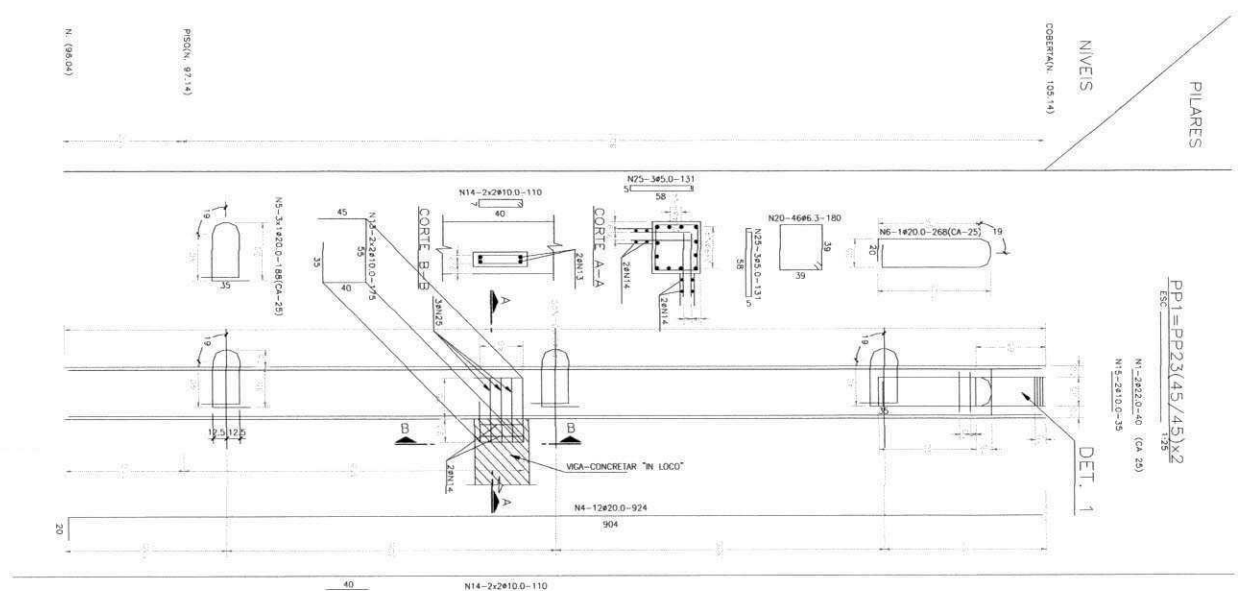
Detalhamento da Armadura dos Pilares do Galpão Principal
